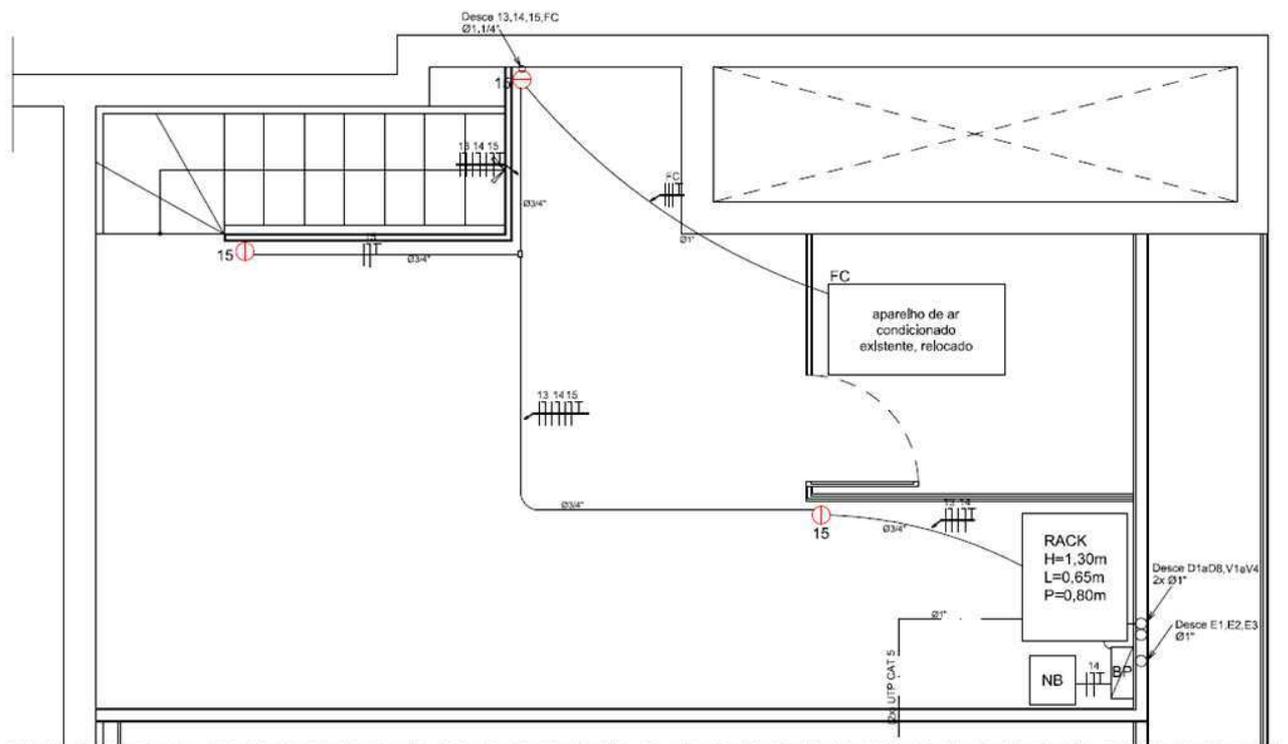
Planta baixa com projeto de iluminação do térreo da loja Calvin Klein Jeans
